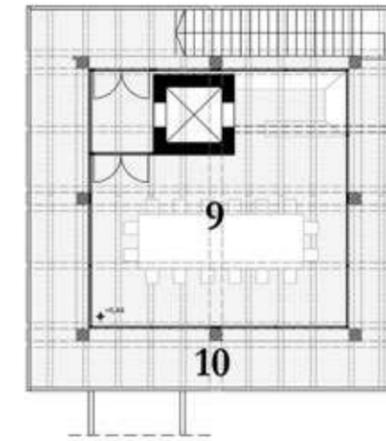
Grundrisse Jagdkanzel, M 1:200
